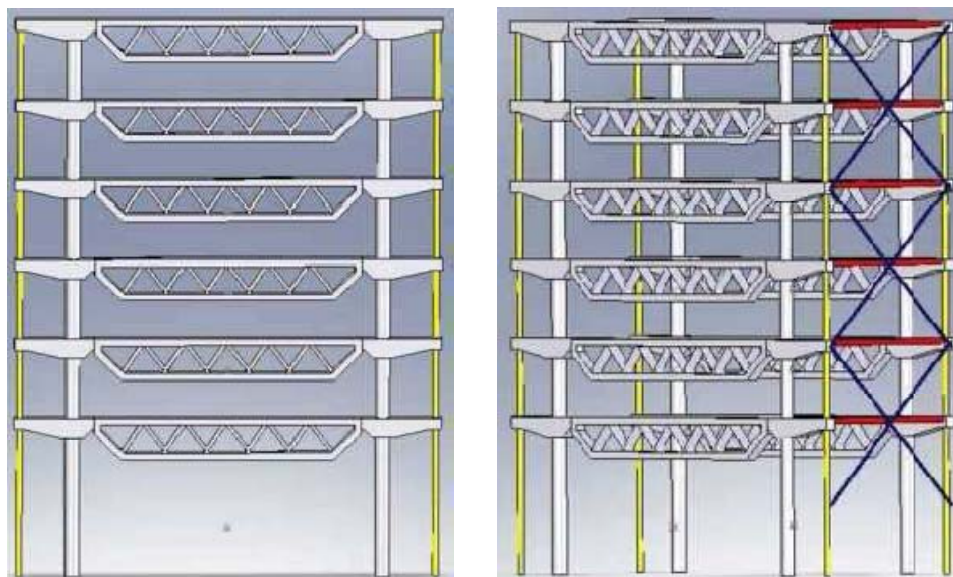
Deux sections montrant les relations entre la poutre, la gerberette et le poteau.
